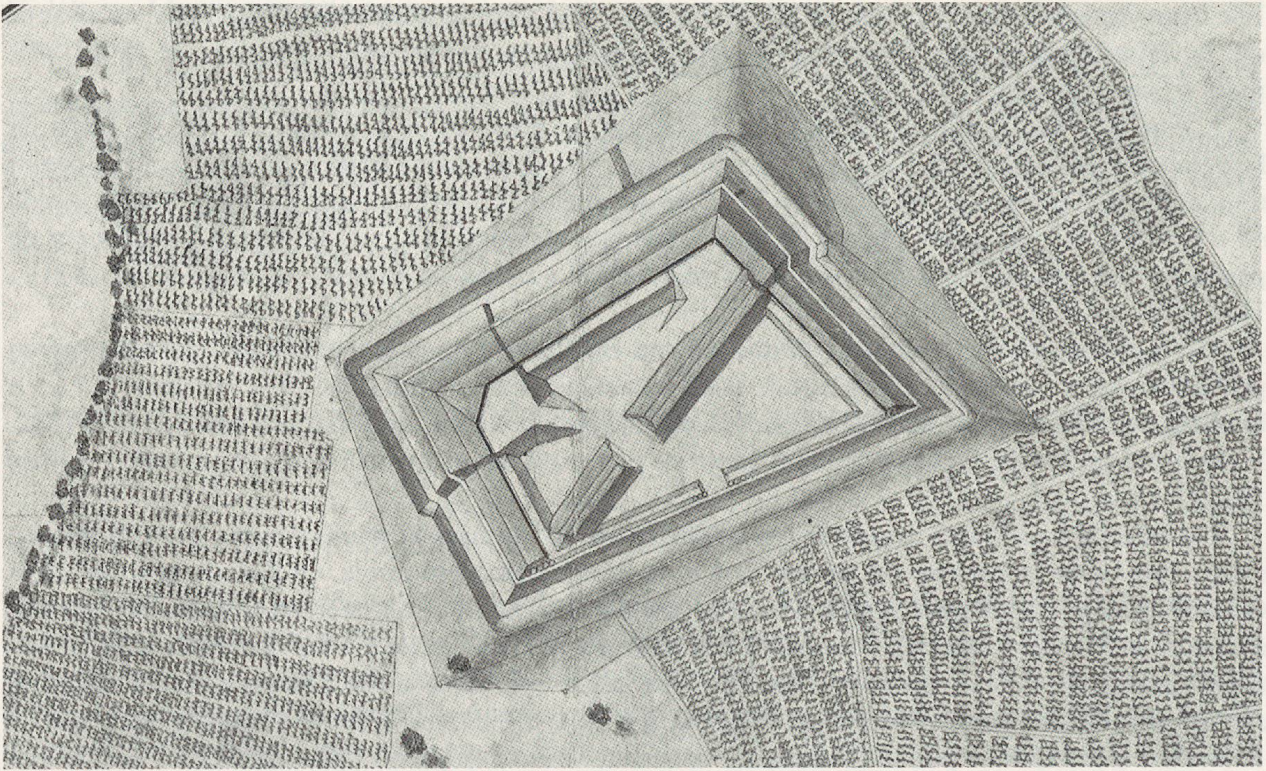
La redoute de la Crête (W 10). Détail du plan Dürr, 1851.
